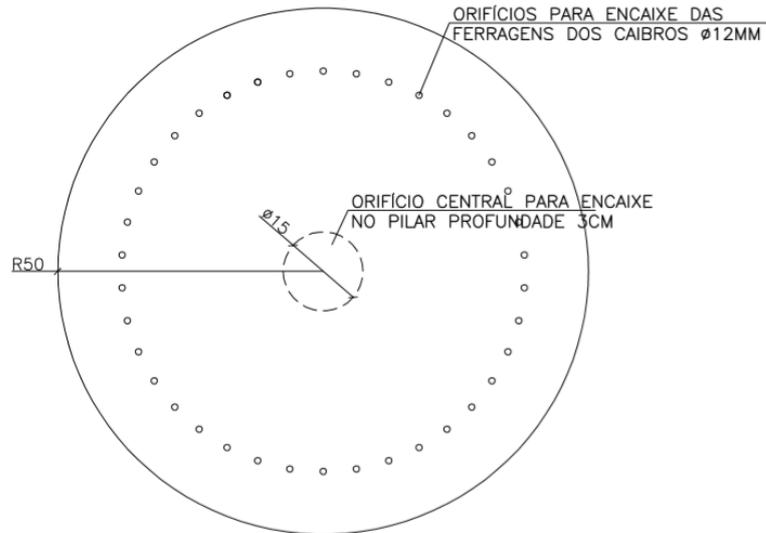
Detalhe da coroa para suporte dos caibros
